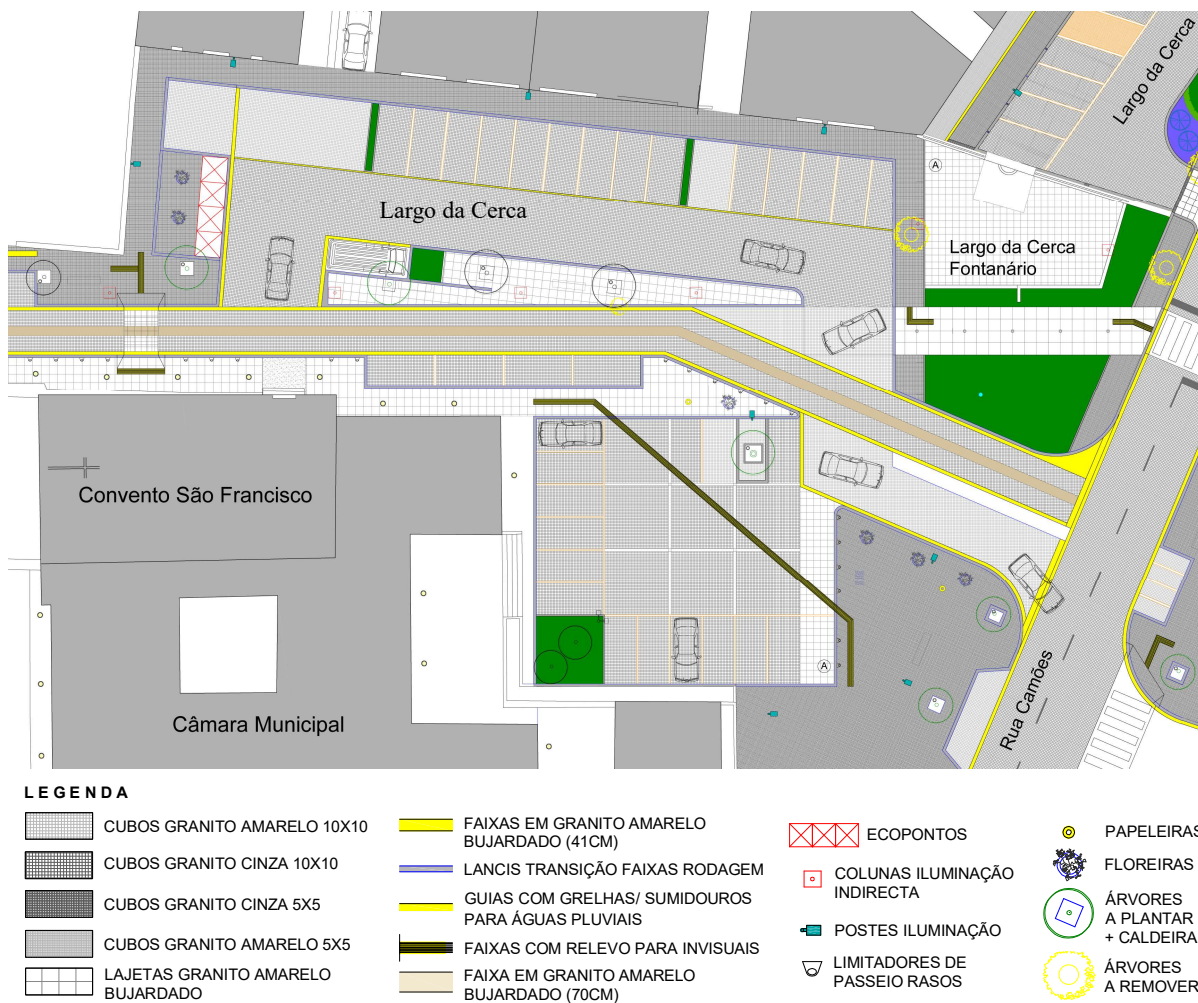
Largo da Cerca – planta da requalificação junto ao Convento de São Francisco (s/esc.)
